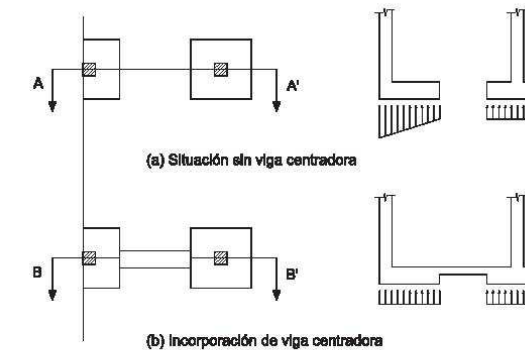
Ejemplo del empleo de vigas centradoras para redistribución de presiones sobre el terreno
